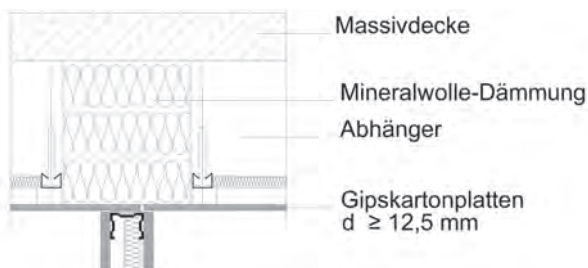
Abgehängte Unterdecke mit Absorberschott (Quelle: Baradiy)
